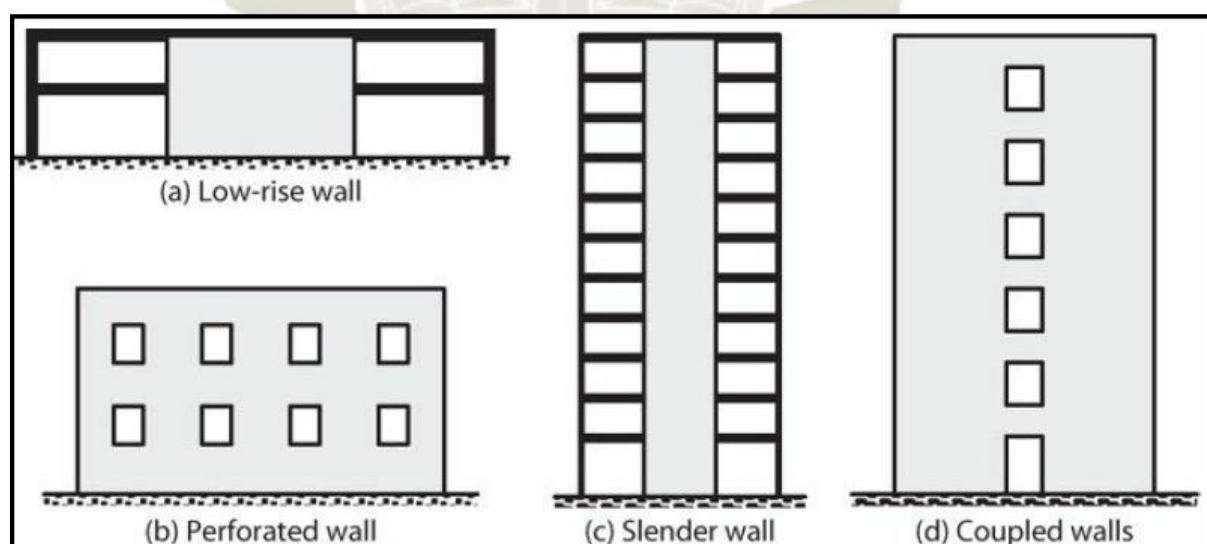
Configuraciones de muros estructurales en edificaciones (Moehle, 2014)
